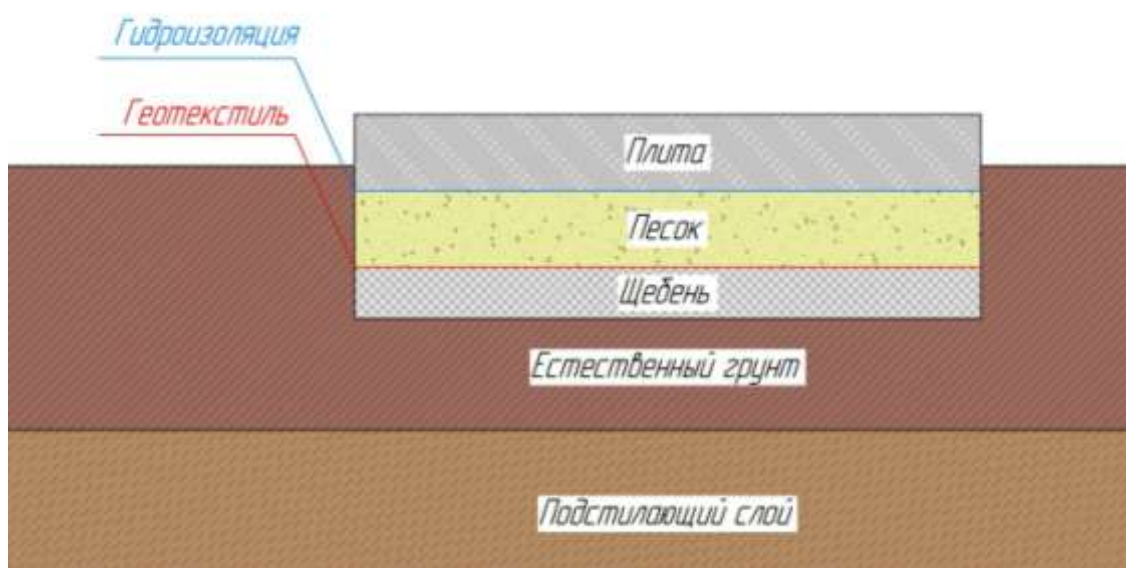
Расположение гидроизоляции и геотекстиля в плитном фундаменте
